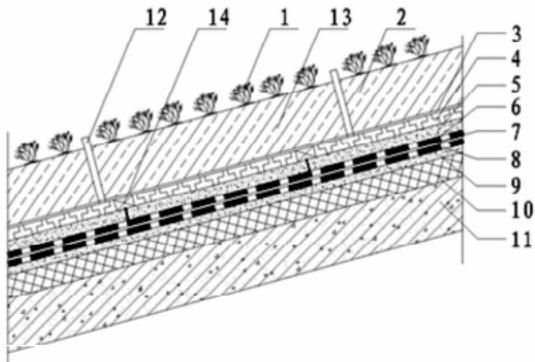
坡屋面种植设计基本构造层次示意图 1
